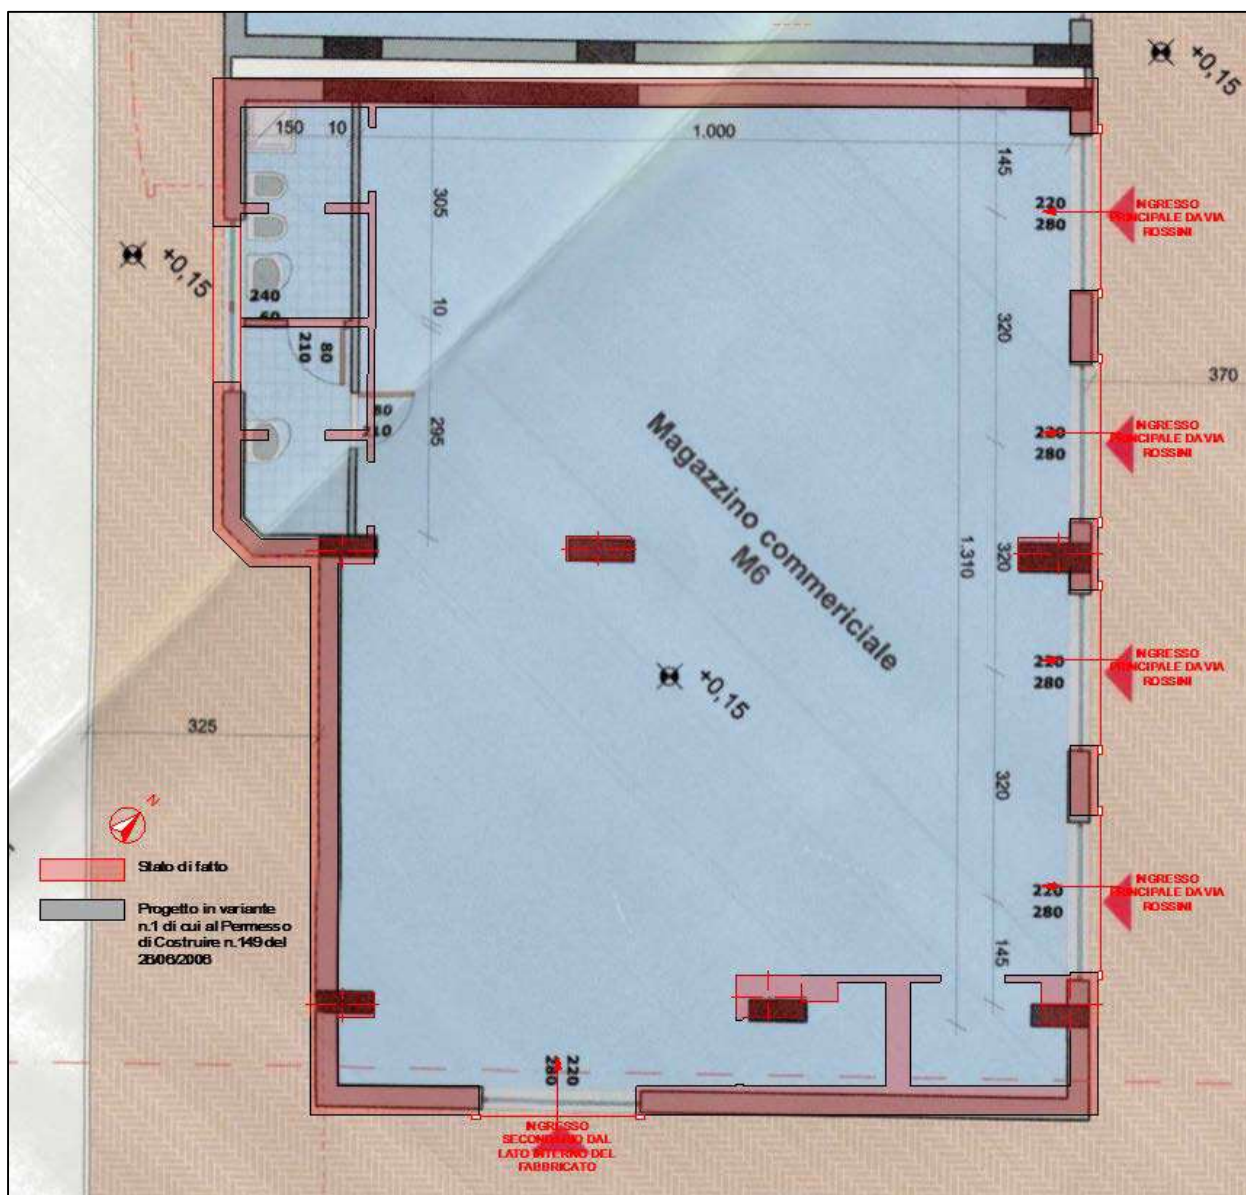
Pianta stato di fatto dell'immobile pignorato sovrapposta alla pianta del progetto in variante n.1 di cui al Permesso di Costruire n.149 del 26 giugno 2006.
